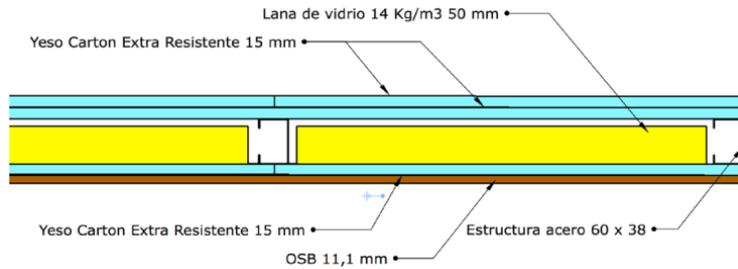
Imagen esquemática de solución constructiva propuesta para muro divisorio.
